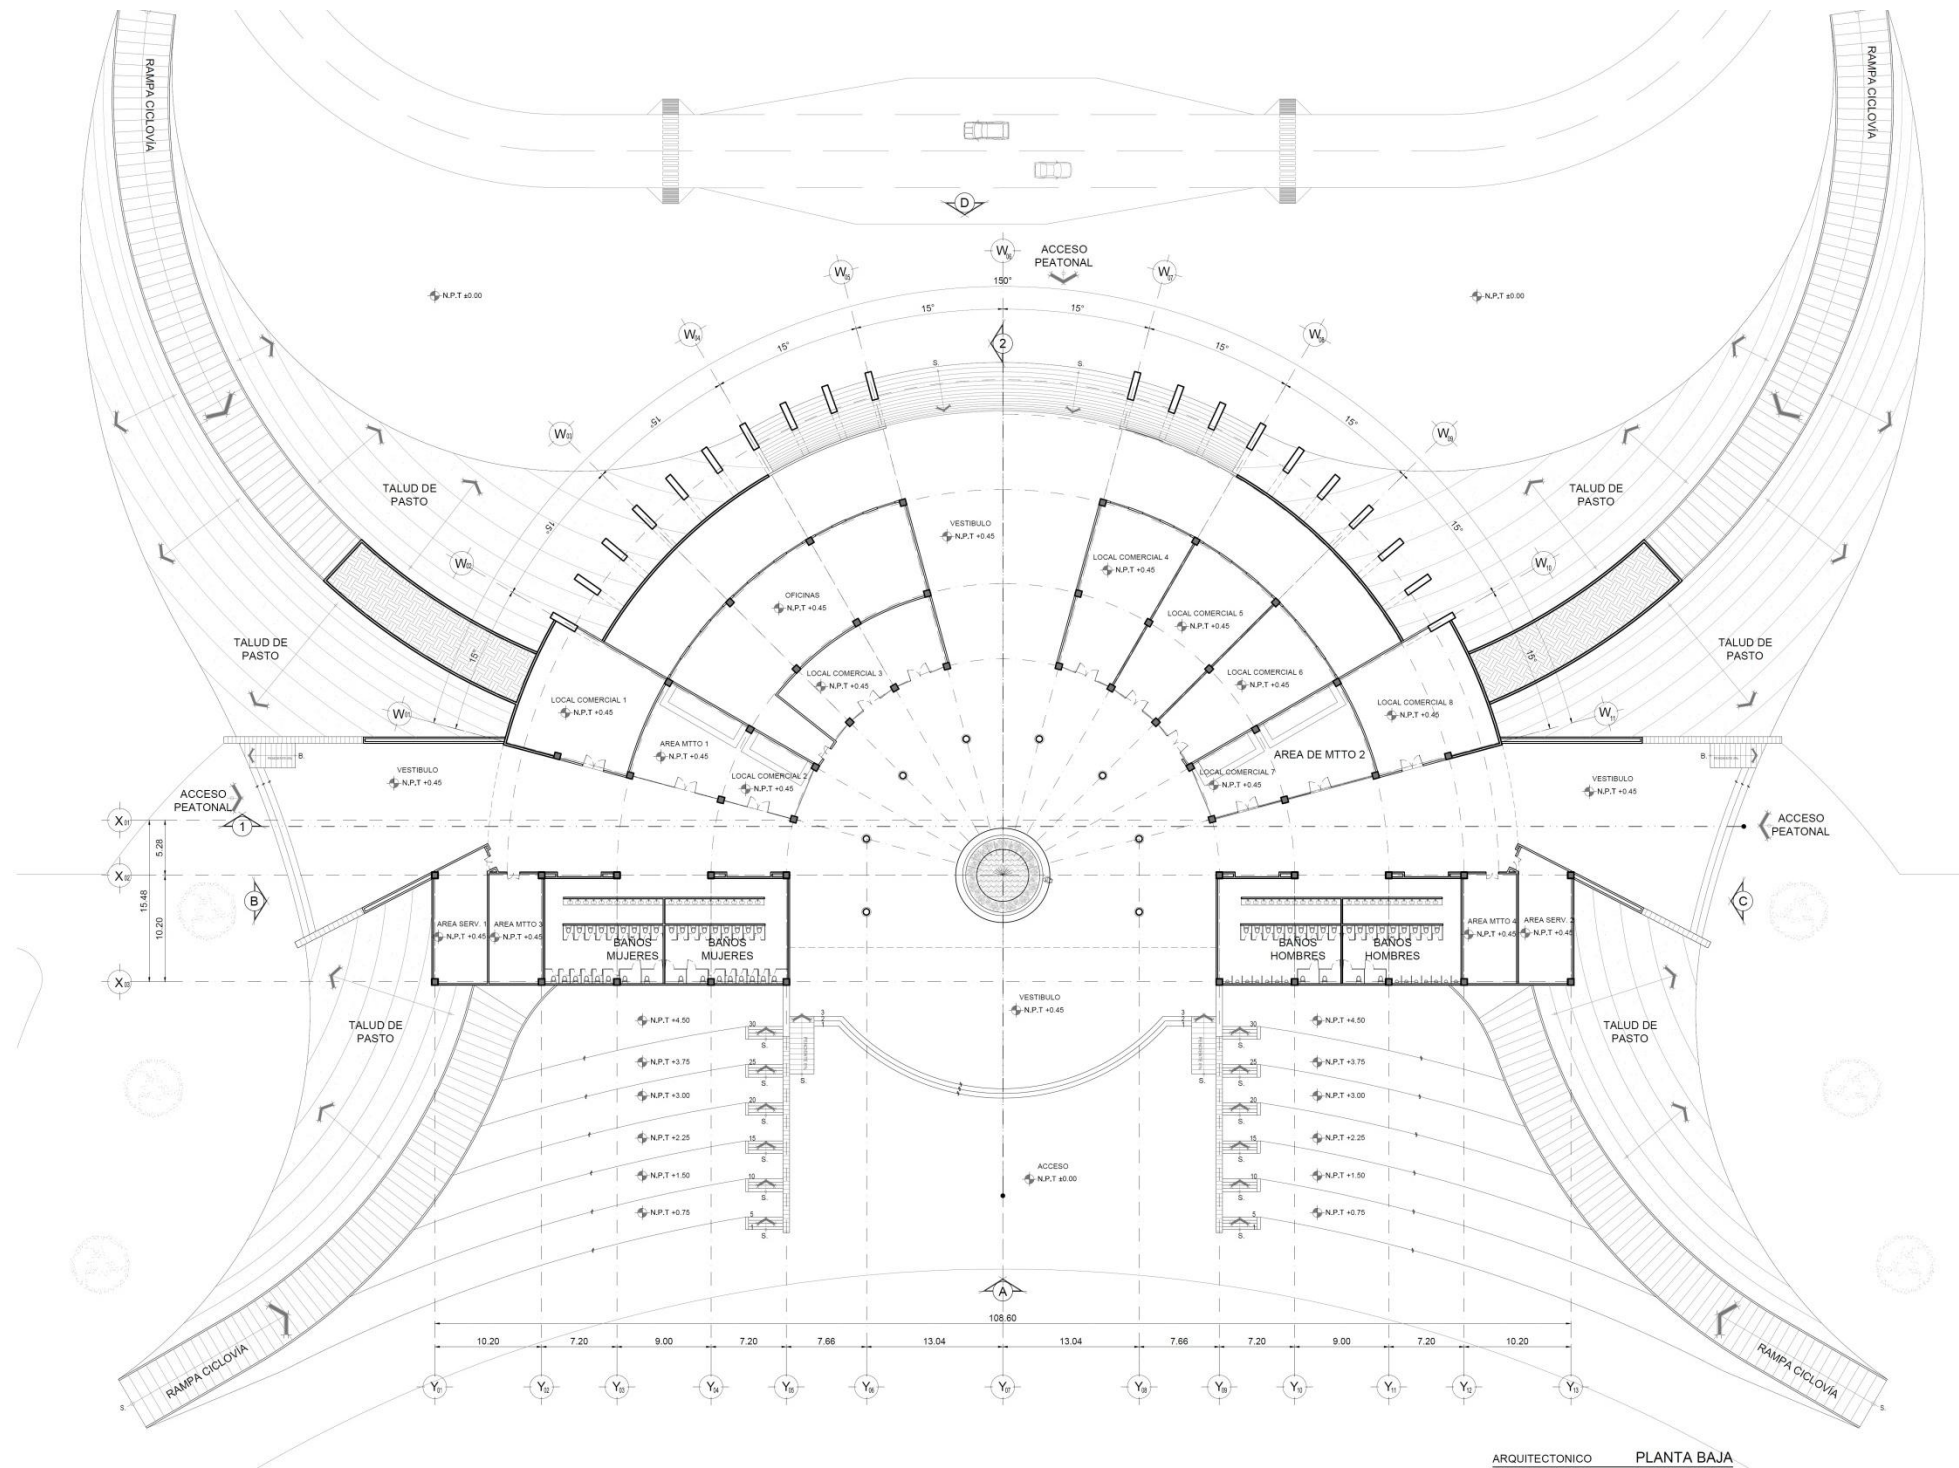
Se muestran las áreas que incluye la plaza central en planta baja.
